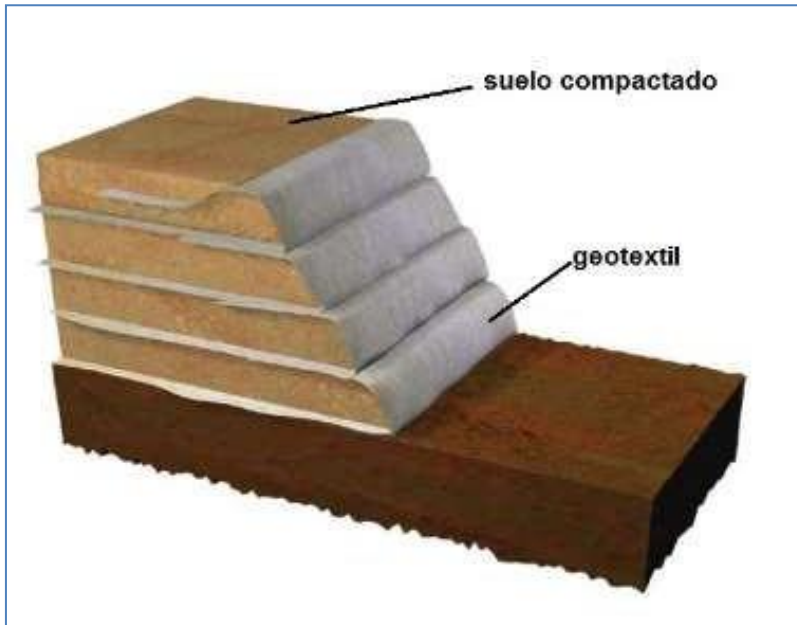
Detalle de la Estructura de un muro reforzado con Geo textil , fuente Geotexan.com
